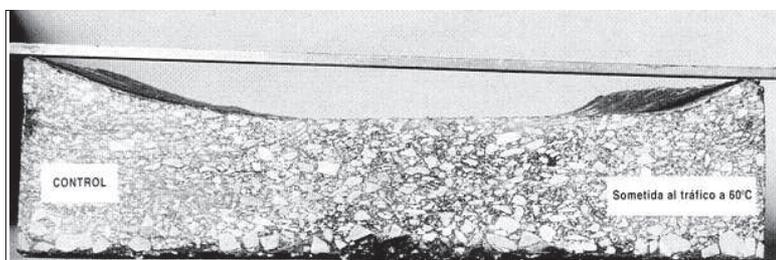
Muestra de Pavimento Asfáltico Convencional
